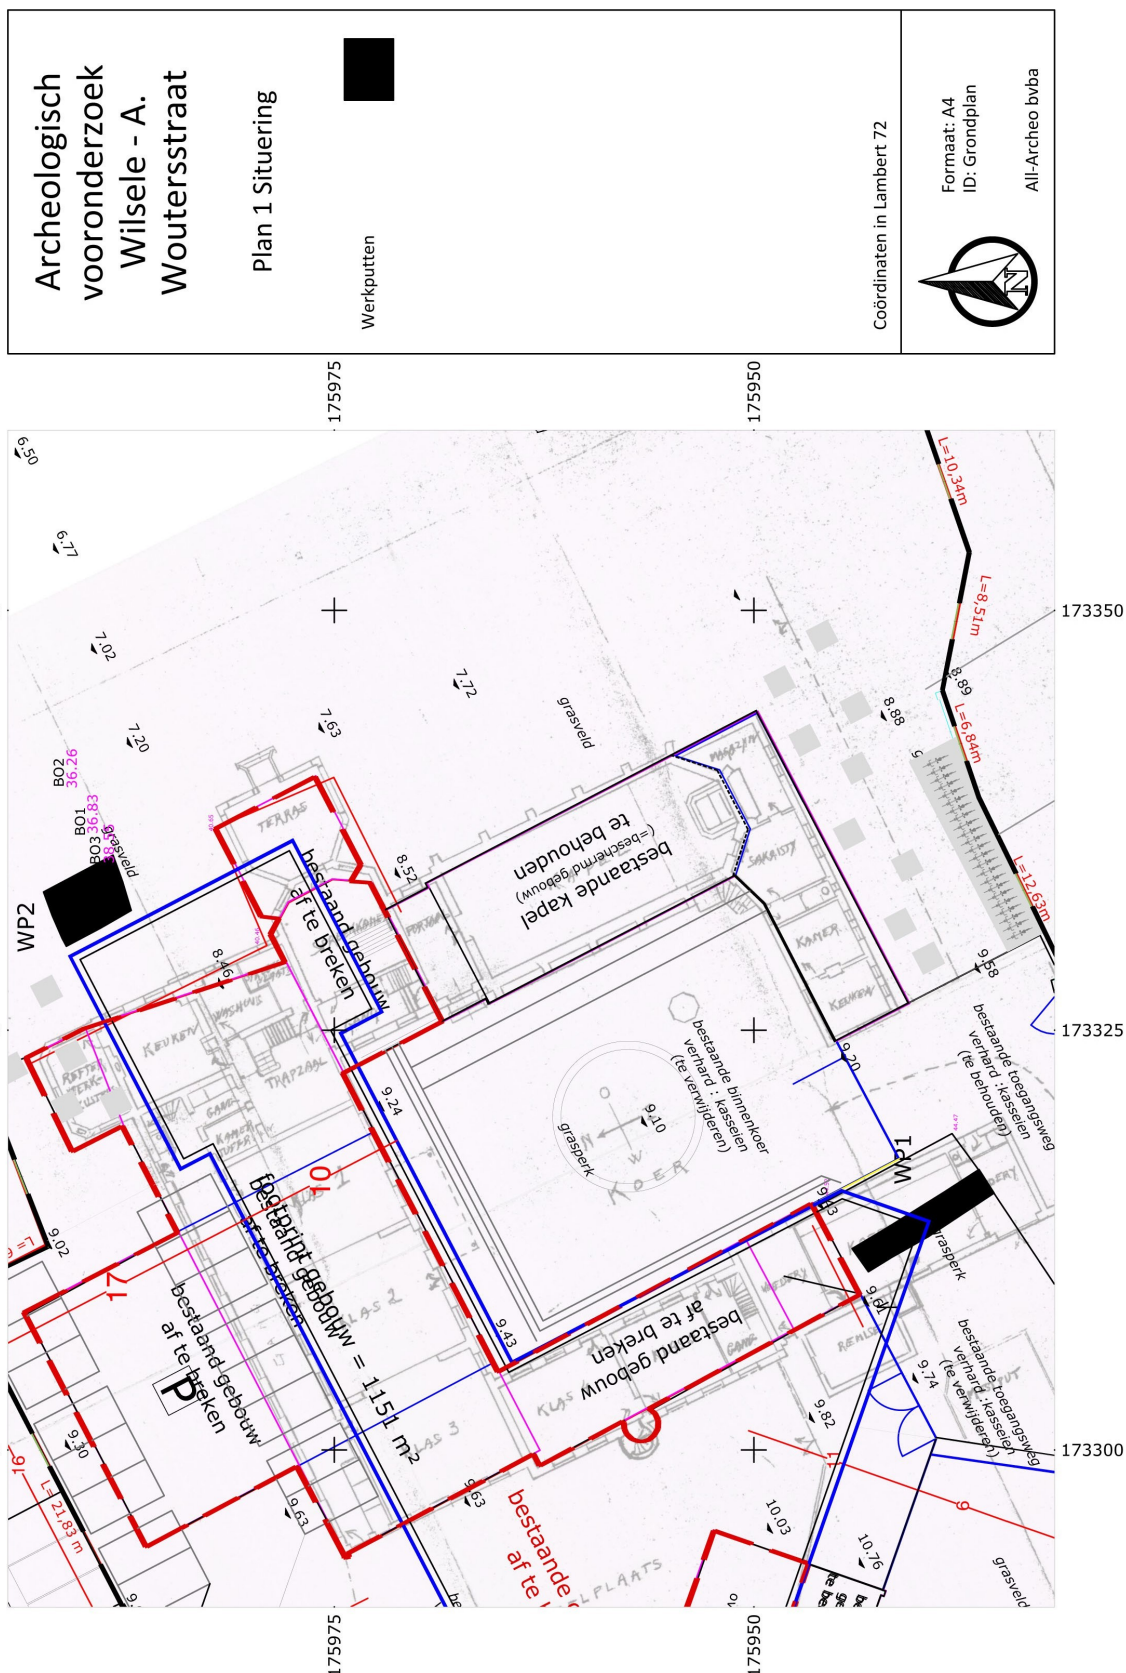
Situeringplan met rood omlijnd de te slopen bebouwing, blauw de geplande nieuwbouw en het grondplan uit 1944 als onderkaart
